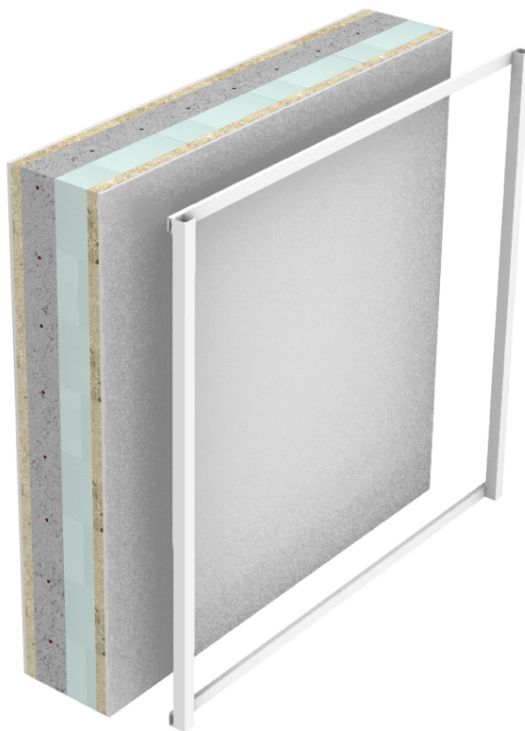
Dettaglio telaio di irrigidimento lamiera
